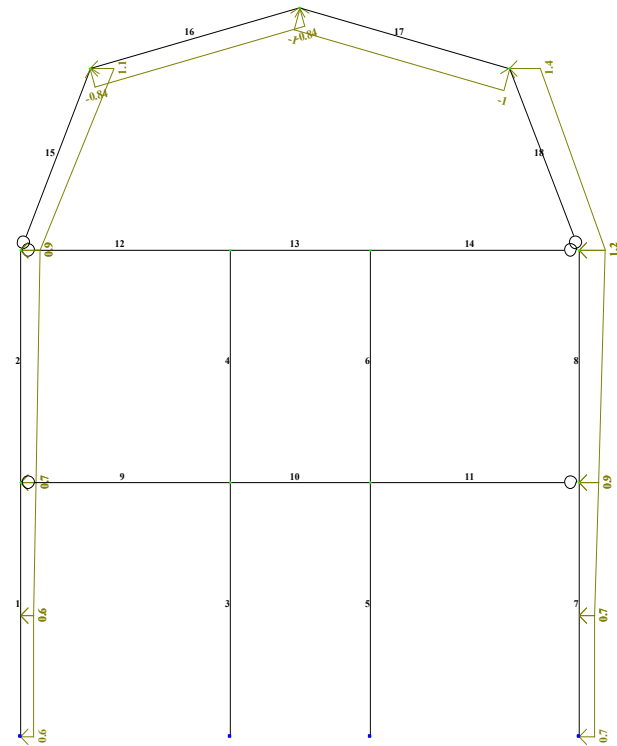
Расчетная схема от ветровой нагрузки(справа).
